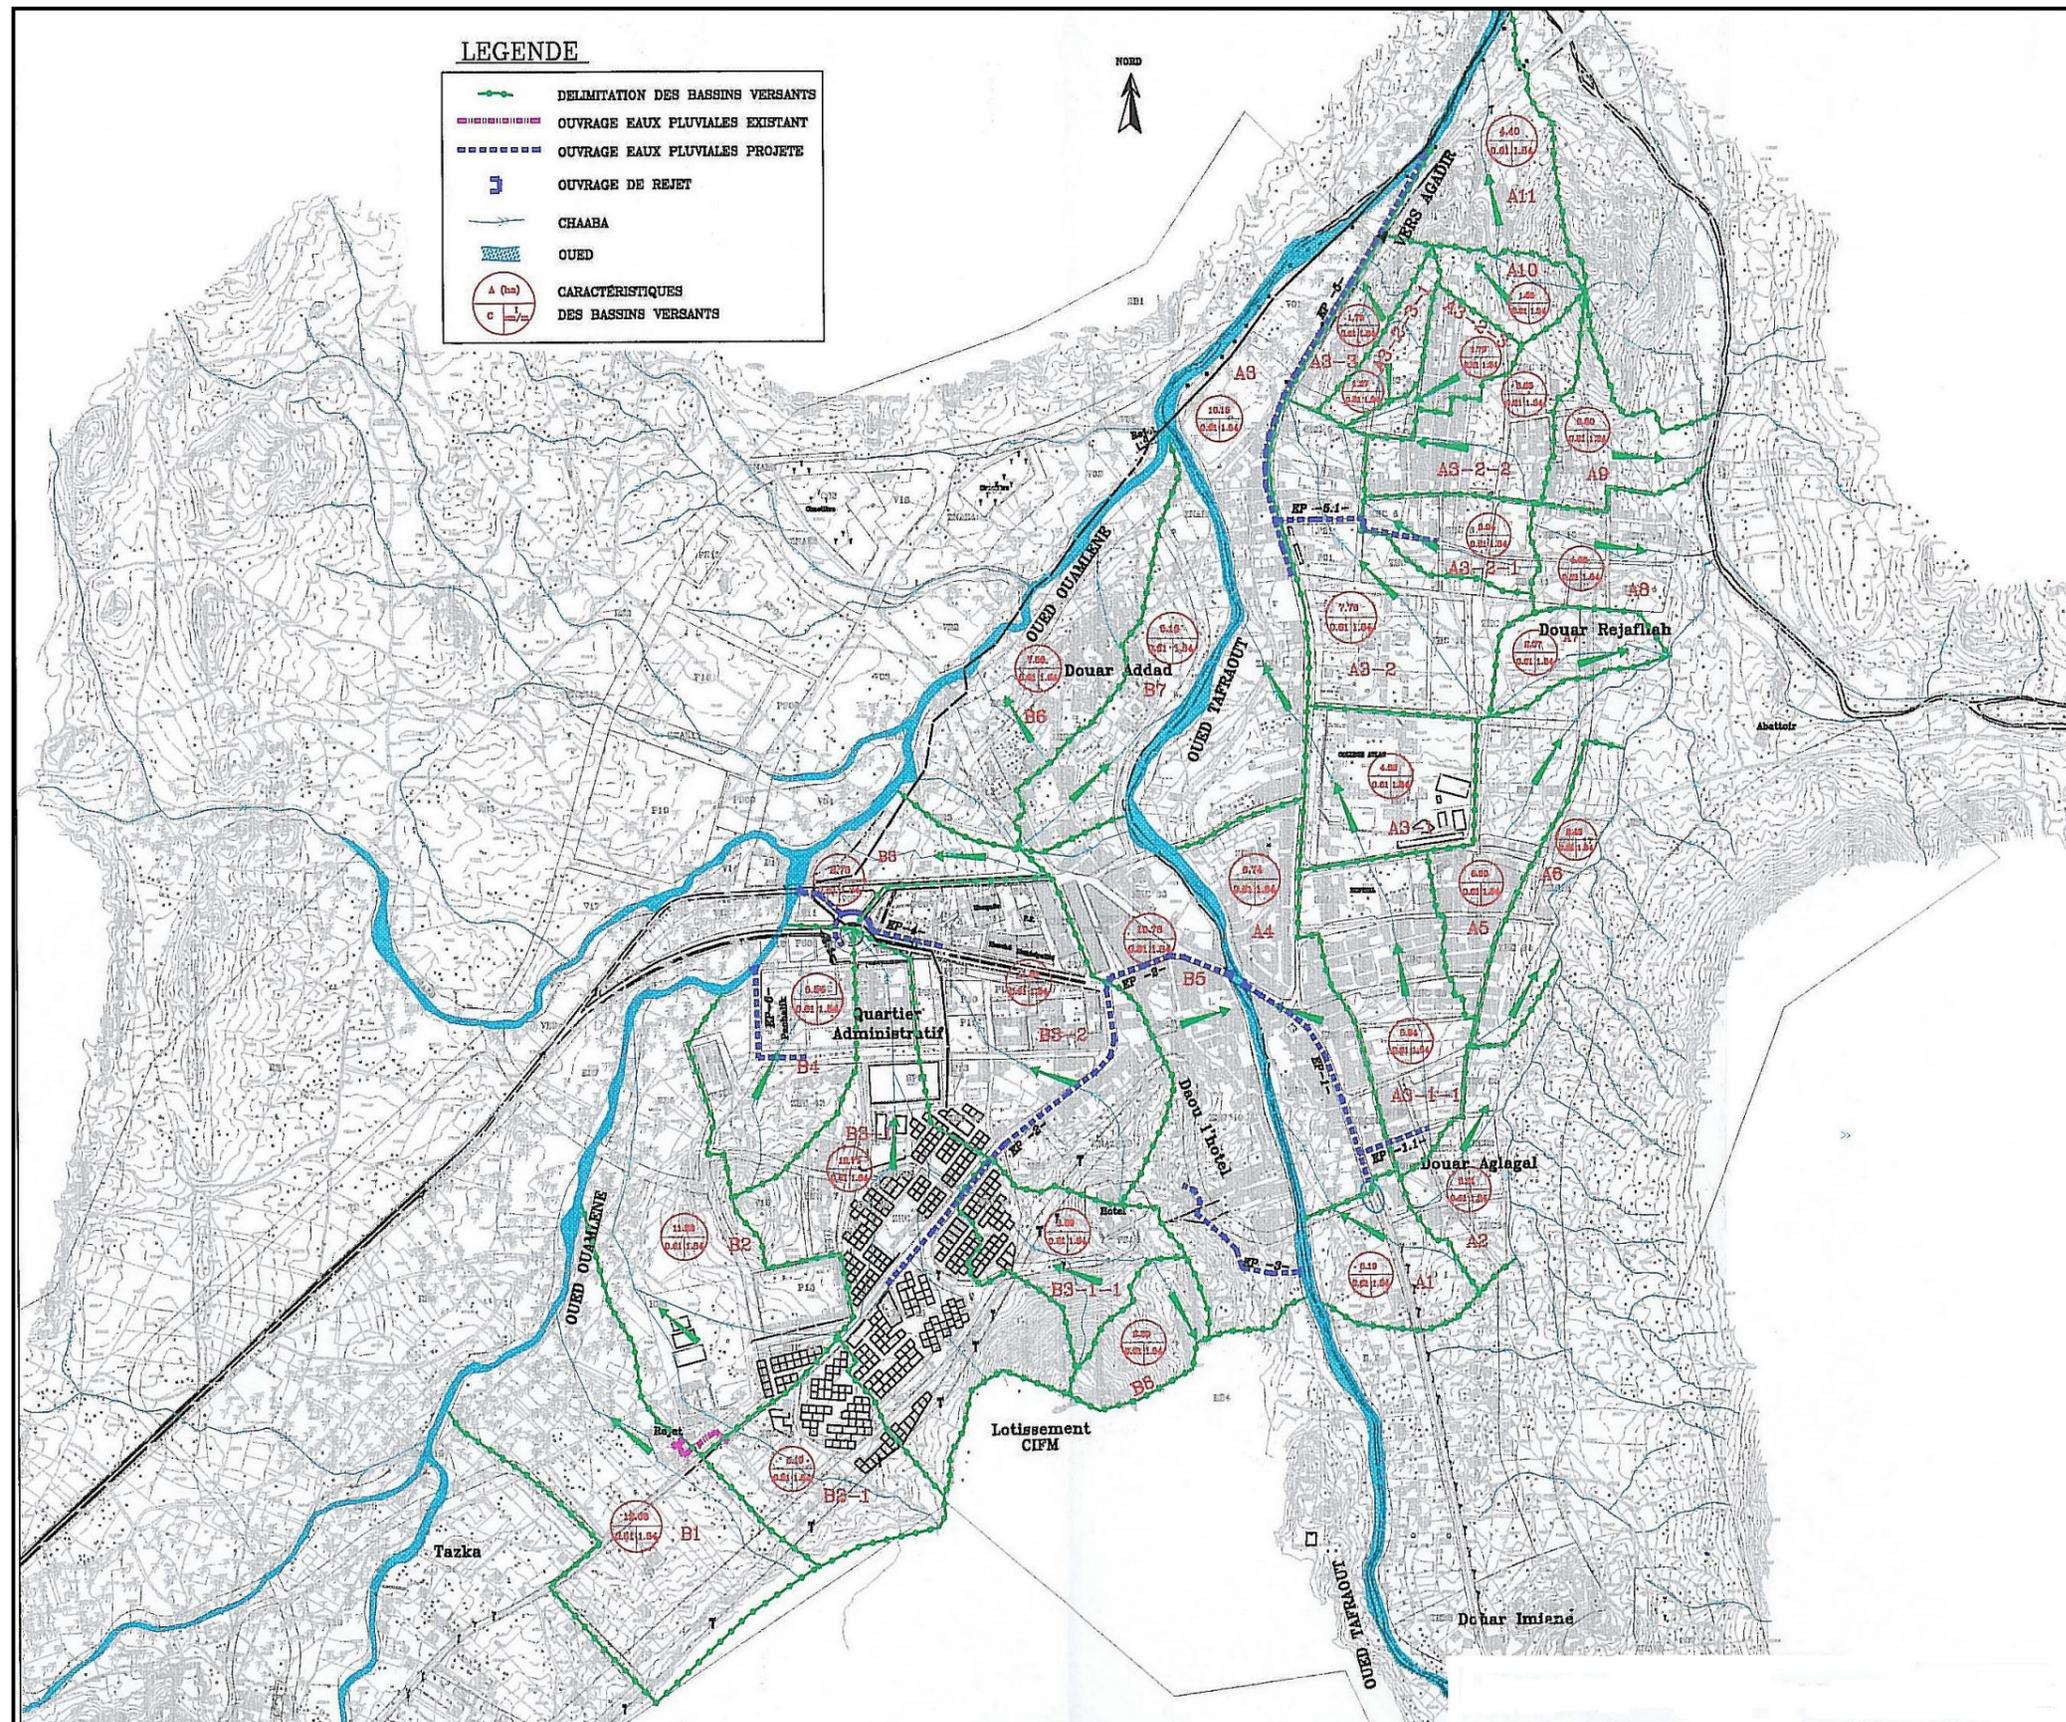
Tracé en plan du réseau projeté des eaux pluviales
